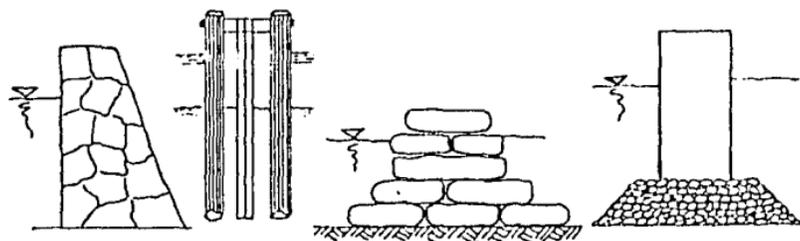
Estructuras de protección costera, de mampostería, tablestacas de madera, bolsacreto, y mixtos respectivamente.
